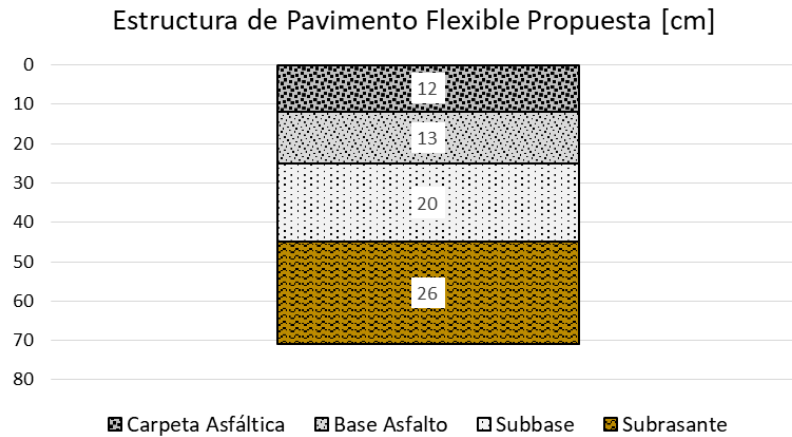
Estructura de Pavimento Flexible Propuesta
